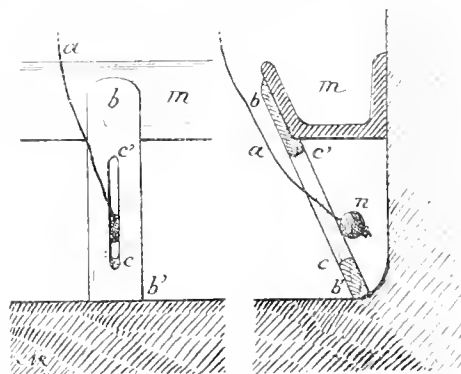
Vue de face et coupe d'un montant d'attache.
